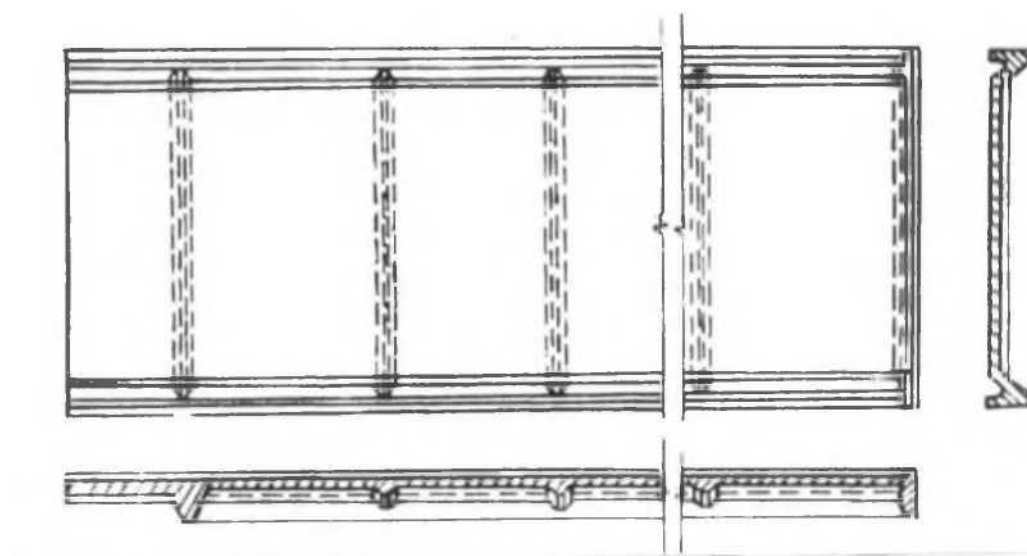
Пример кровельной плиты складчатого сечения с полкой в сжатой зоне для крыш с наружным водоотводом
